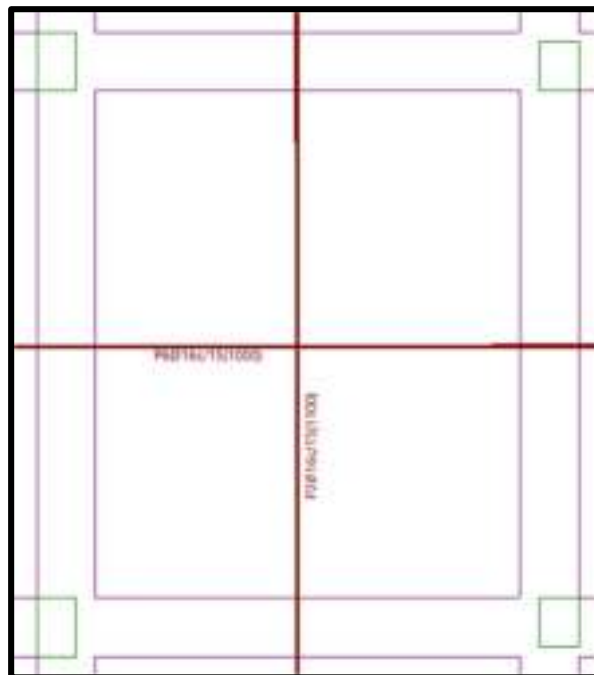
Esquema de armado longitudinal y transversal inferior de la losa de Cimentación s/ CBH – 87
